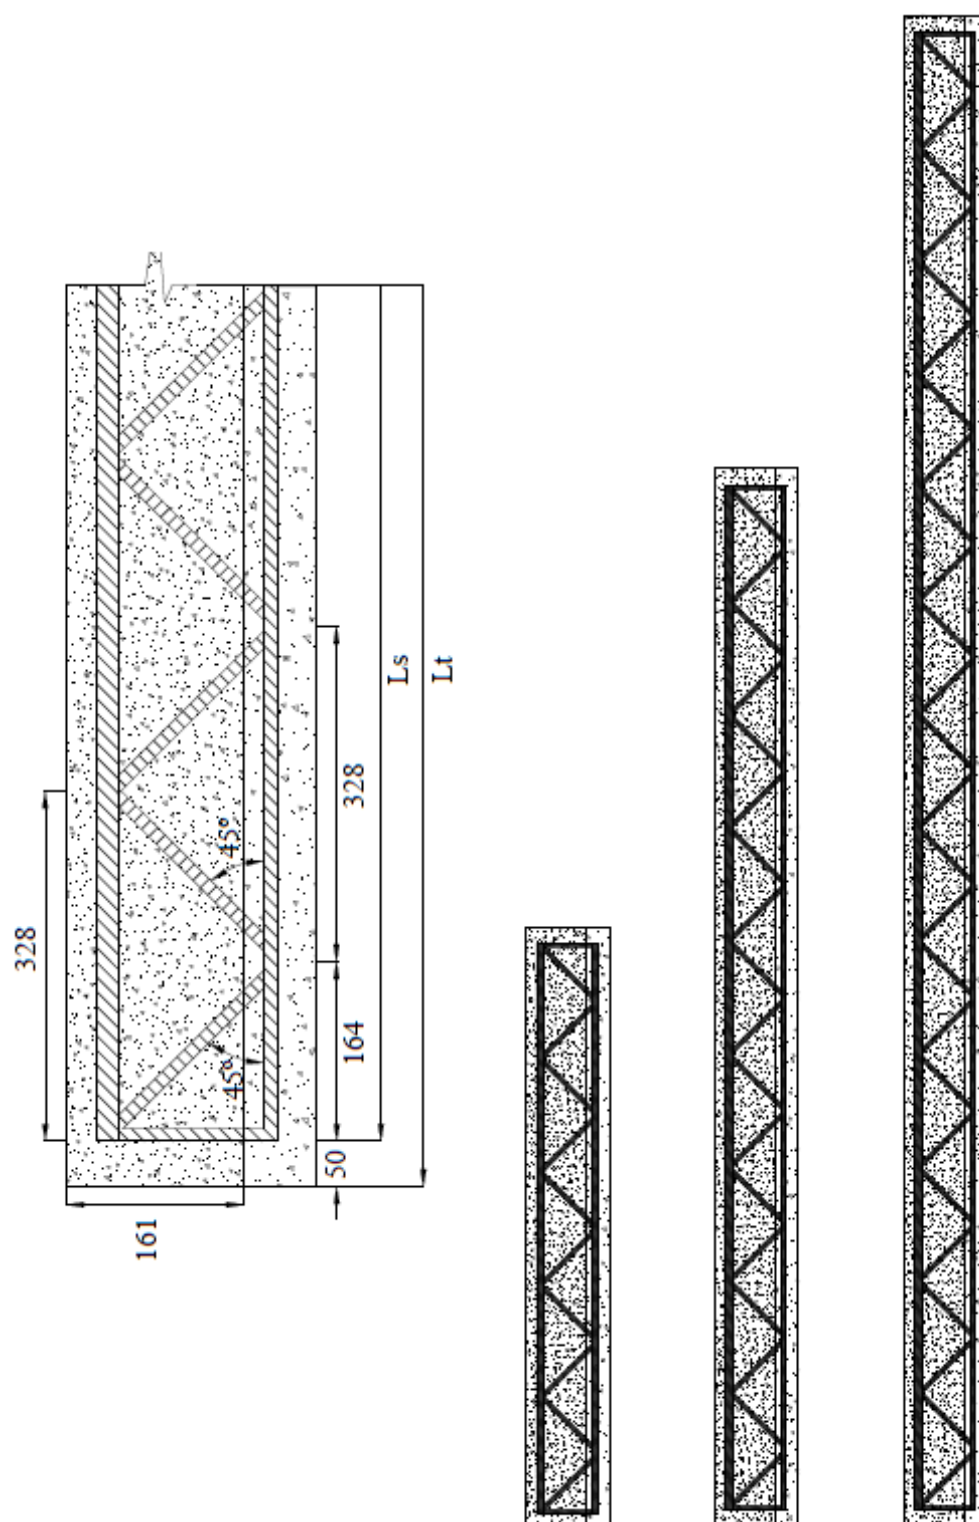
Secciones Longitudinales fase SII, tipo B
